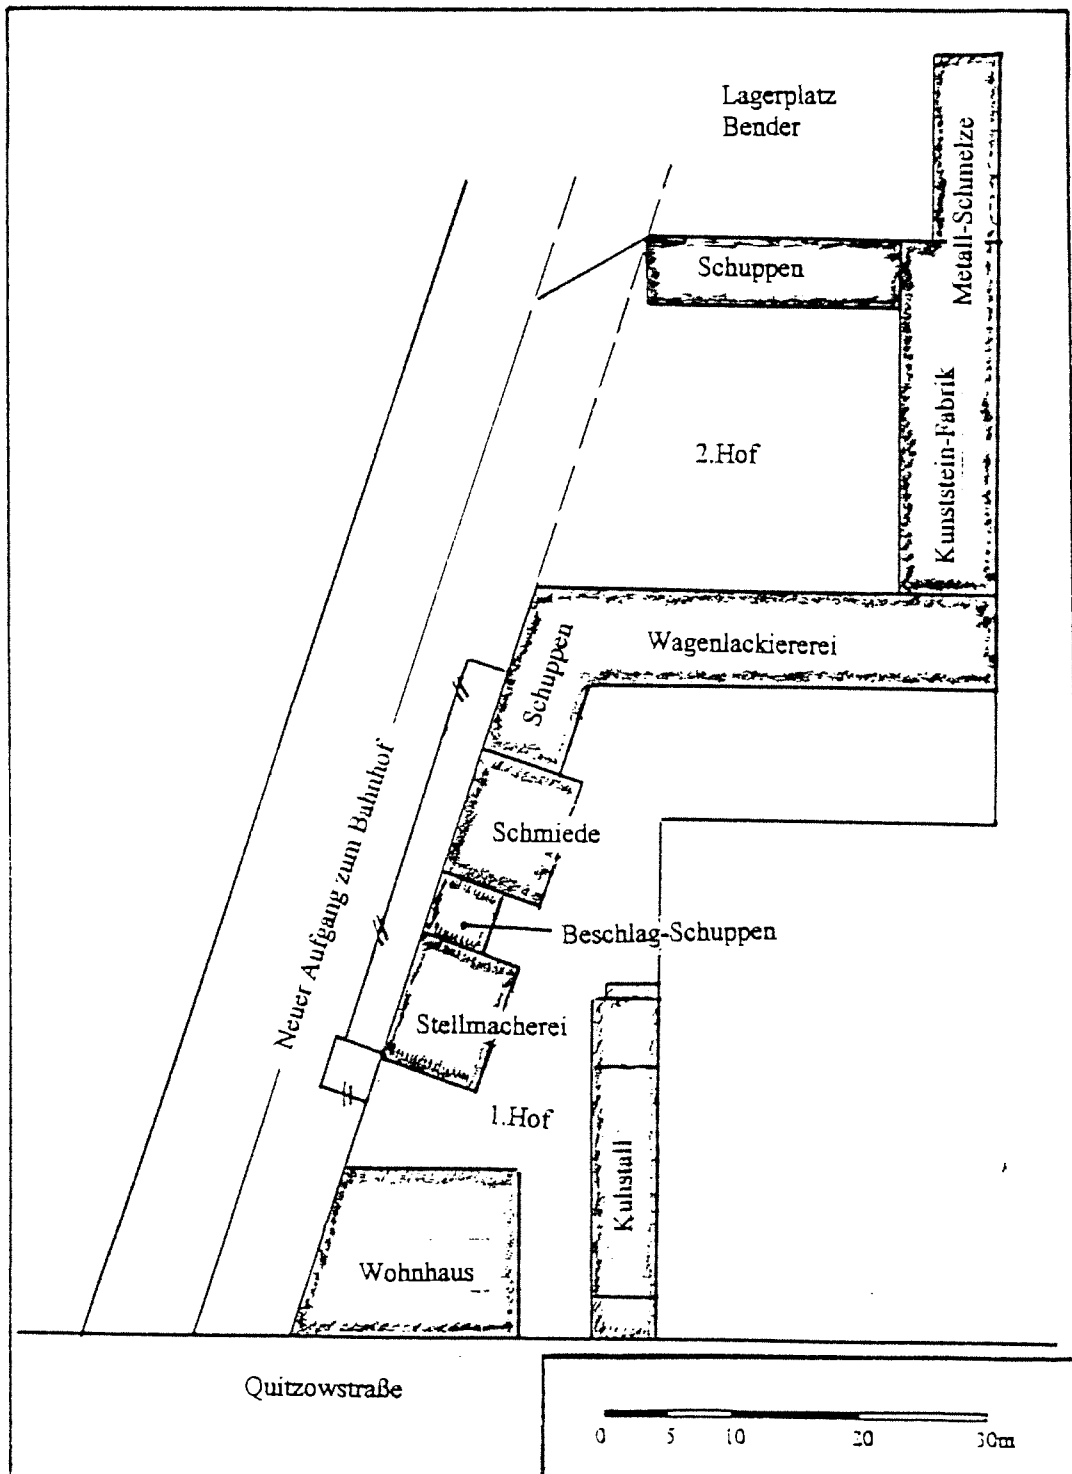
a : Verdachtsfläche 13 - Bebauungssituation 1896/1911 (Nr.62-63)
